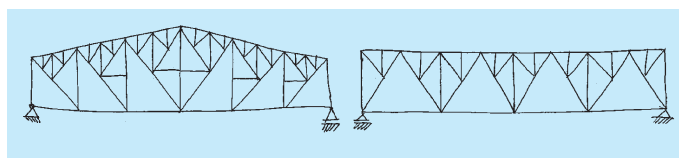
Фермы больших пролетов со шпренгельной решеткой
